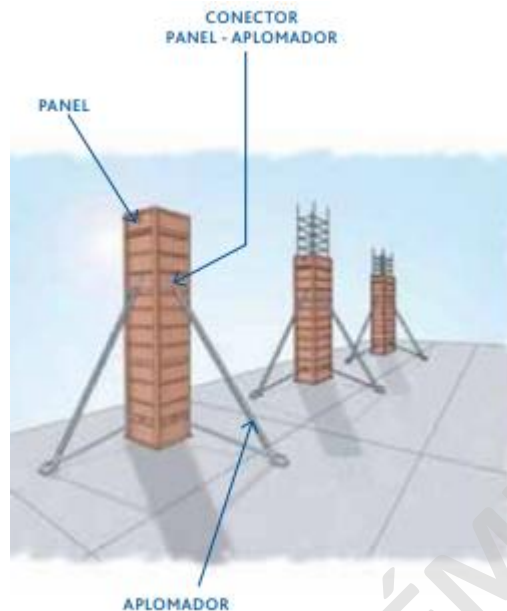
Elementos que componen un moldaje de pilares y columnas. (Manual de moldajes, Cámara Chilena de la Construcción, 2014)
